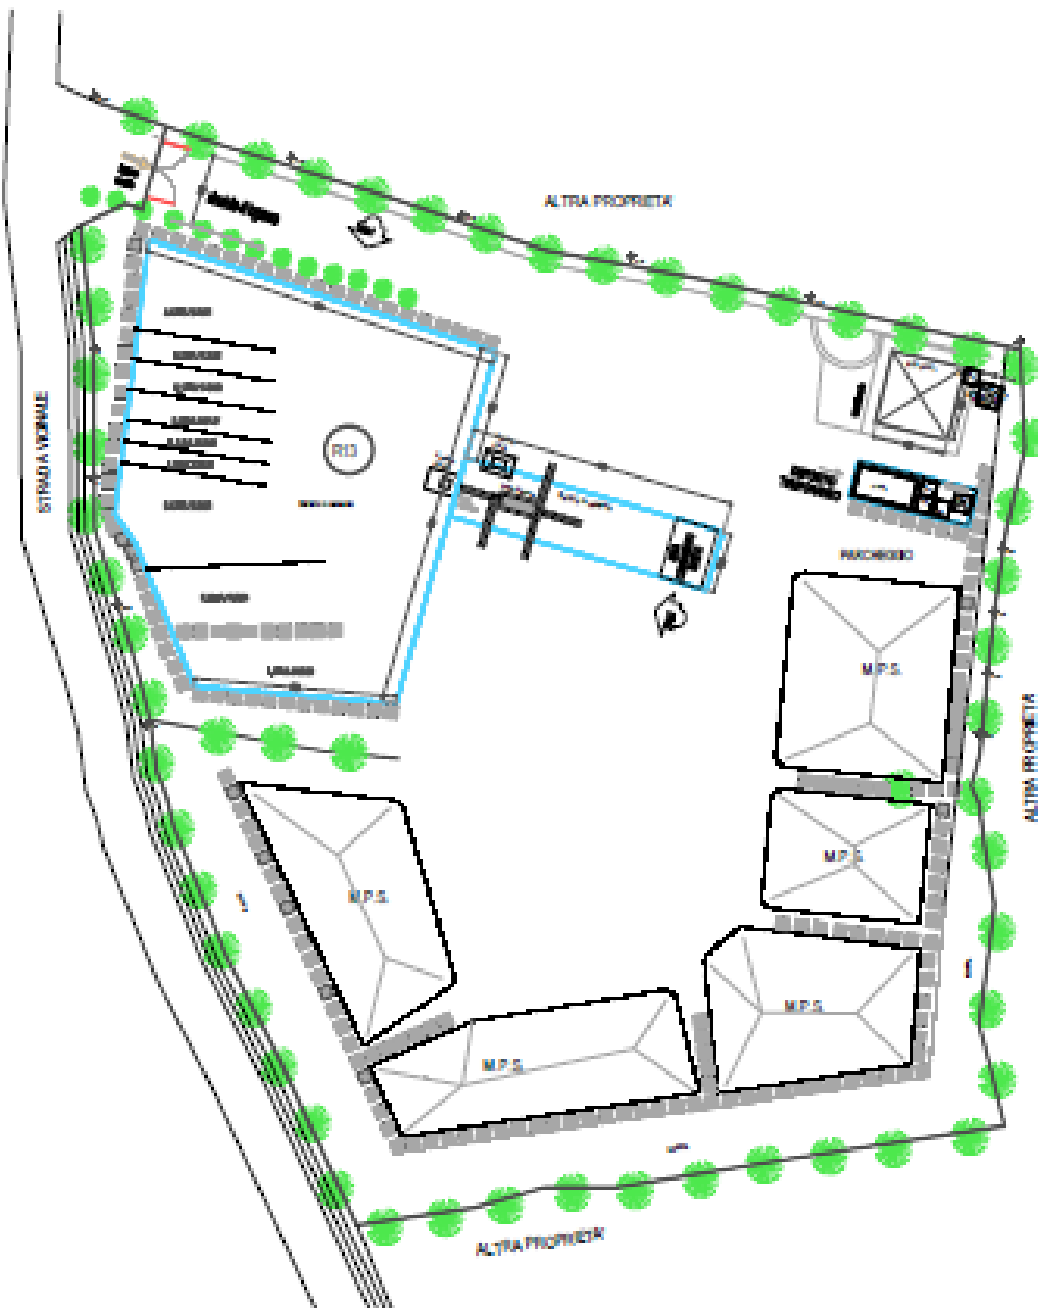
planimetria dell'impianto di frantumazione inerti Ecoserra Srl
